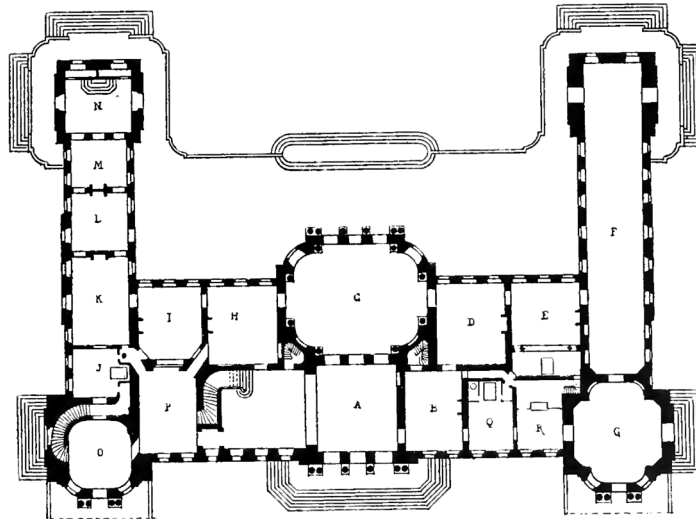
Plan d'une habitation de plaisance, d'après Blondel. — Rez-de-chaussée.
